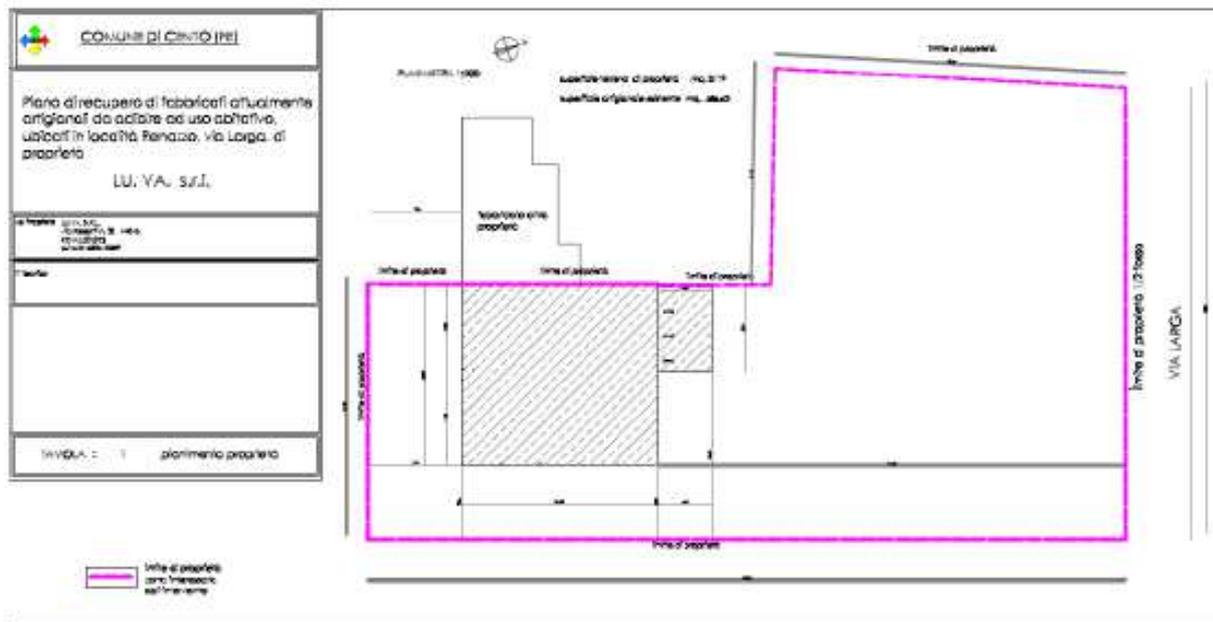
Planimetria del lotto con indicazione dell'area oggetto di recupero
